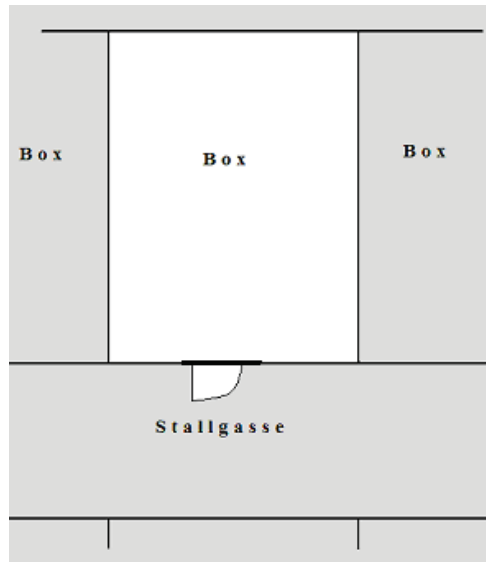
Grundriss einer „Außenbox Stallgasse“
